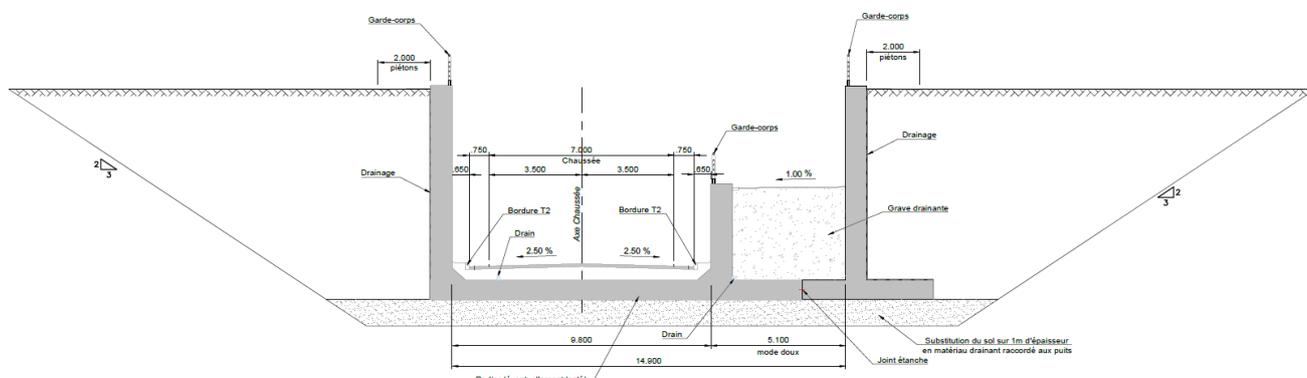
Coupe type de la structure de la trémie hors Pont SNCF
